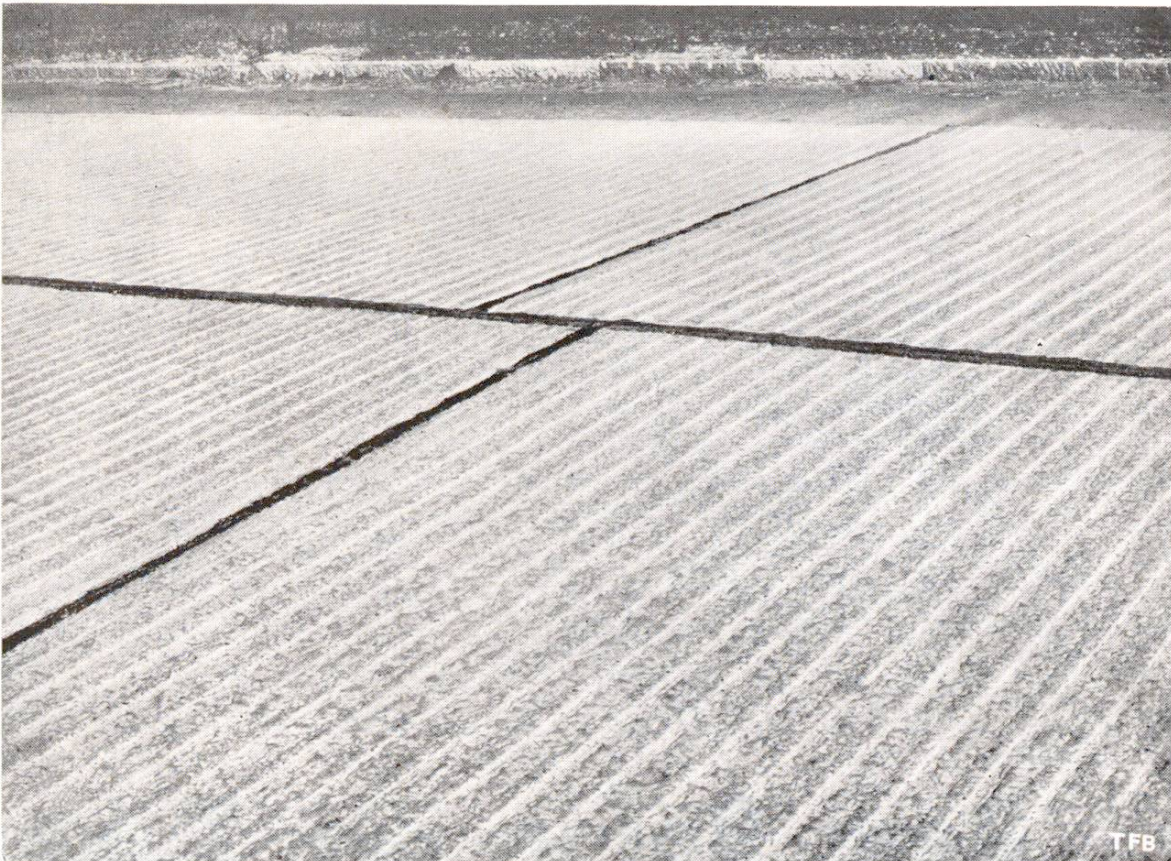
Betonoberfläche mit starker Riffelung (Kreuzlingen)
